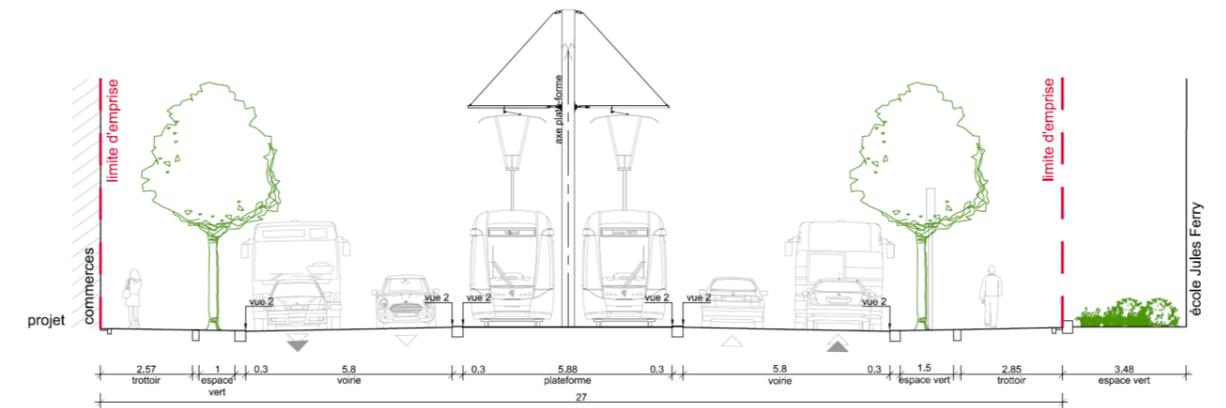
Coupe type entre les stations Stade Delaune et Pyramide.
